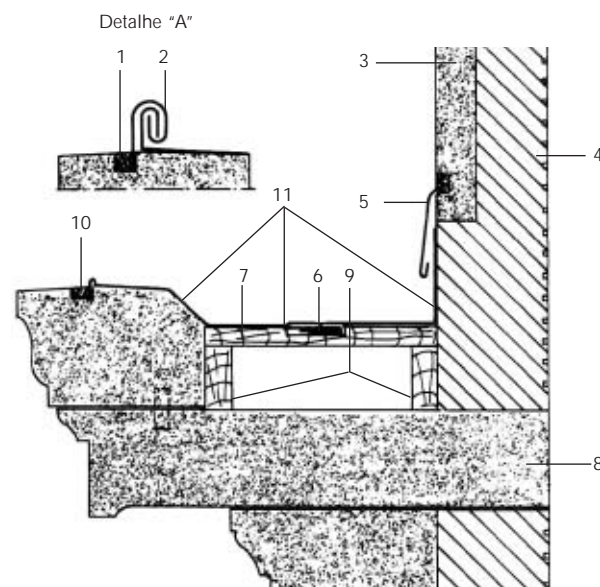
Calha de cobre com suporte base de concreto e / ou pedra.
